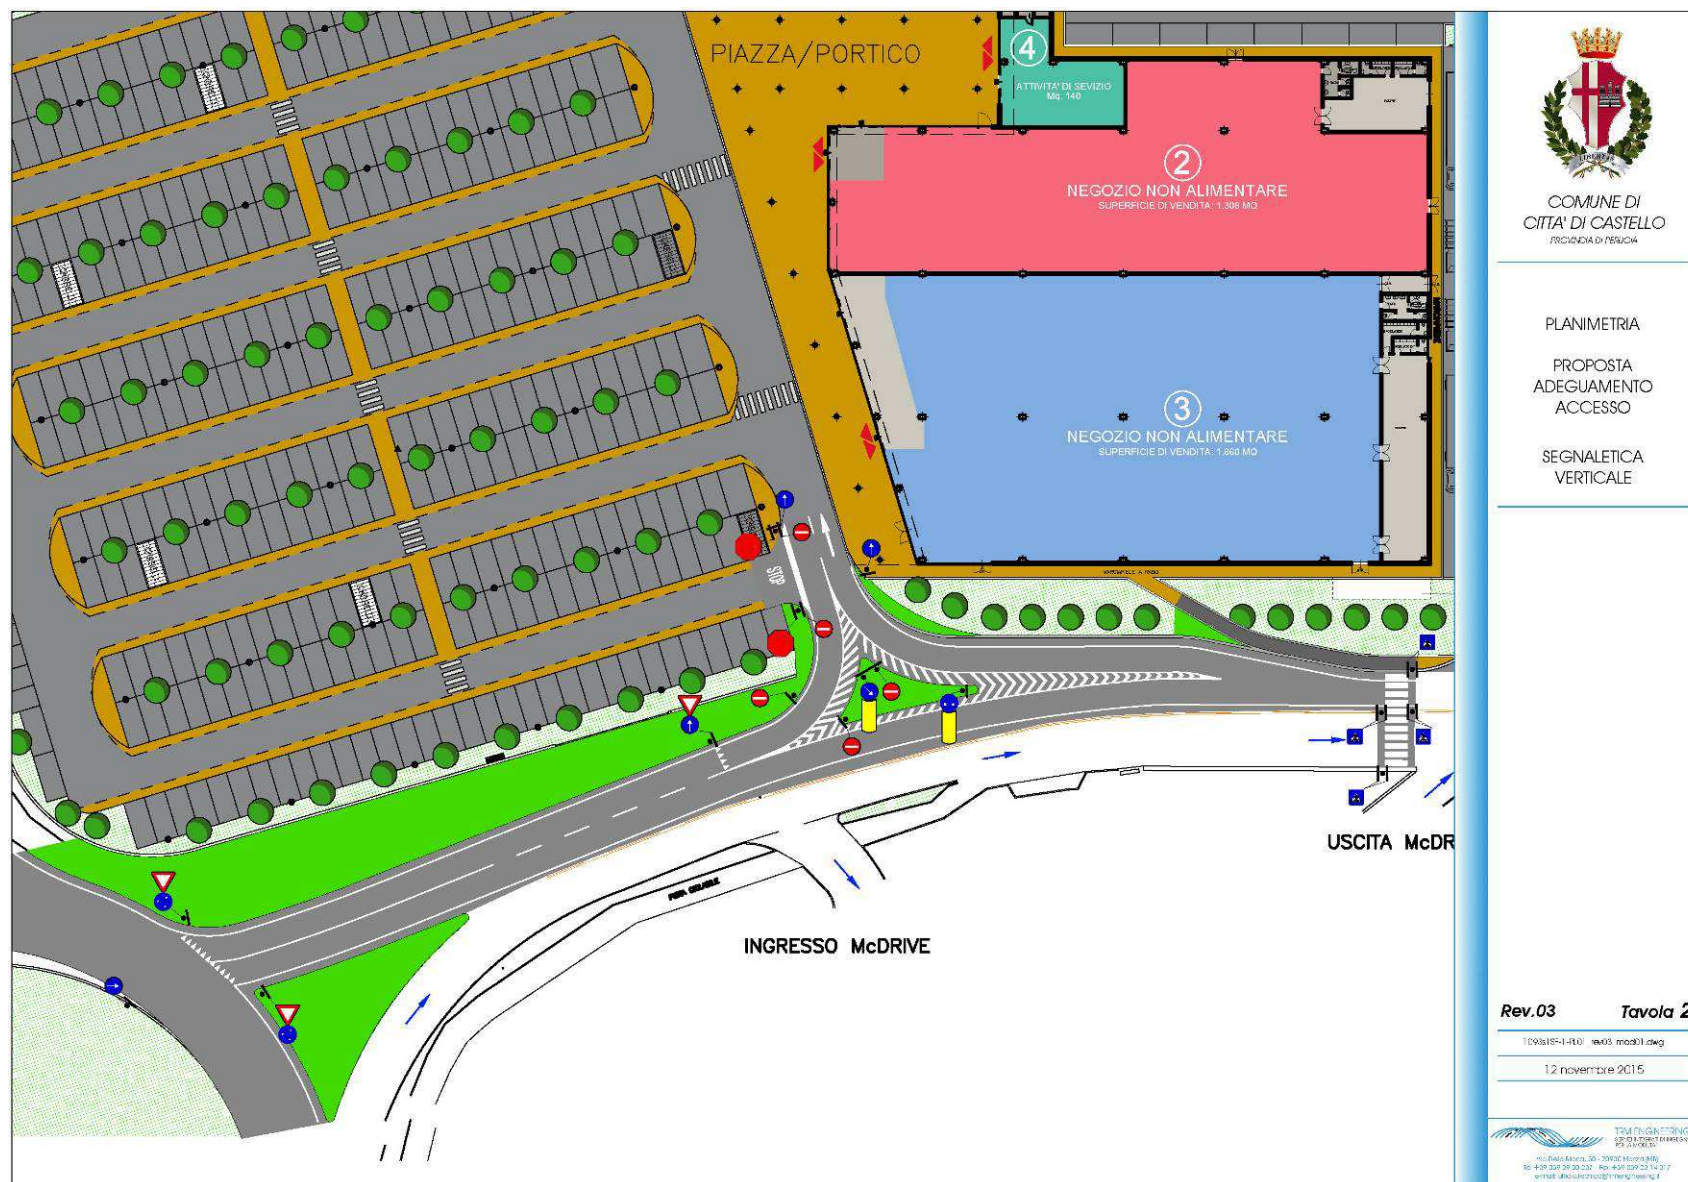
Planimetria – Proposta adeguamento accesso – Segnaletica verticale
